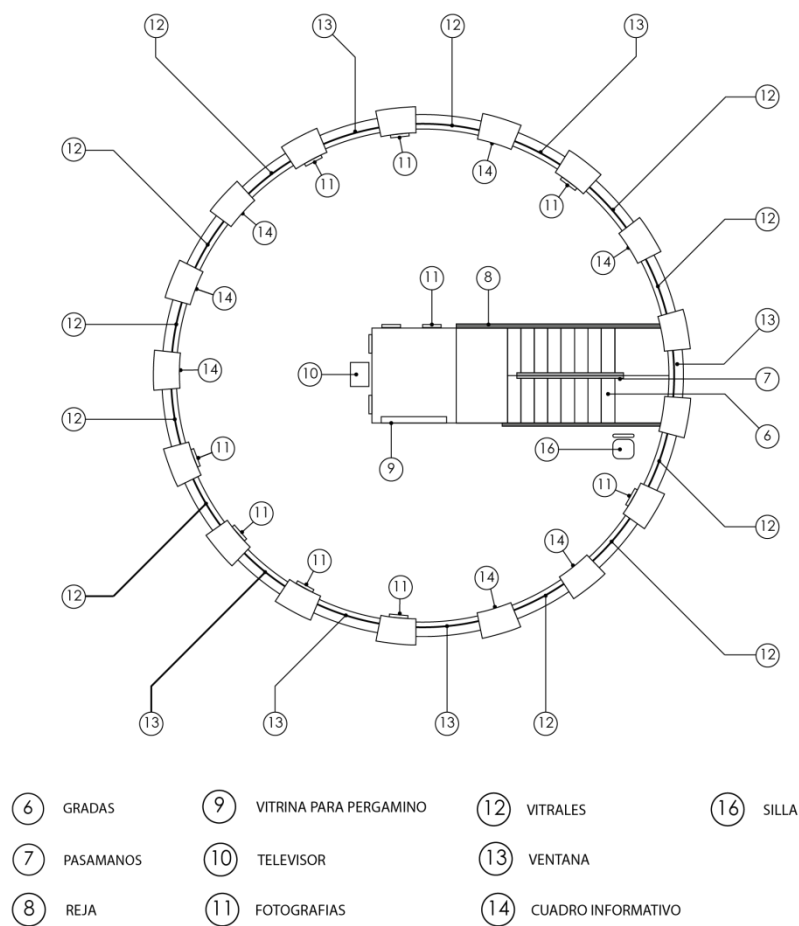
Planos de elementos existentes en el Museo. Imagen generada por André Cueva.
